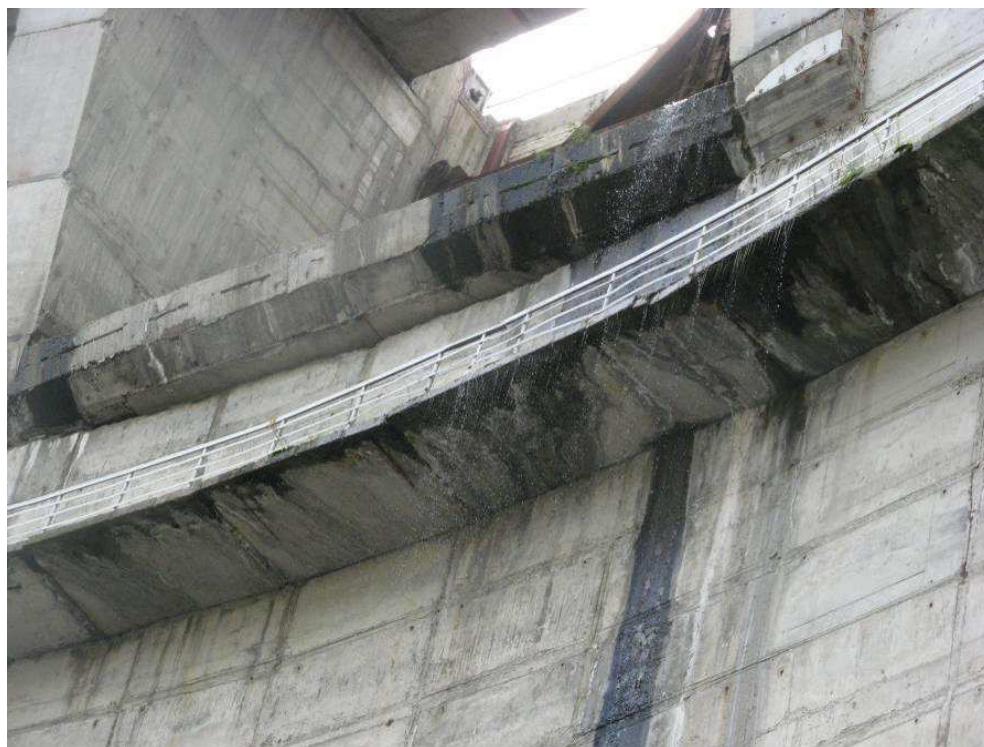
Следы выщелачивания и нарушение защитного слоя бетона с оголением арматуры снизу балкона
